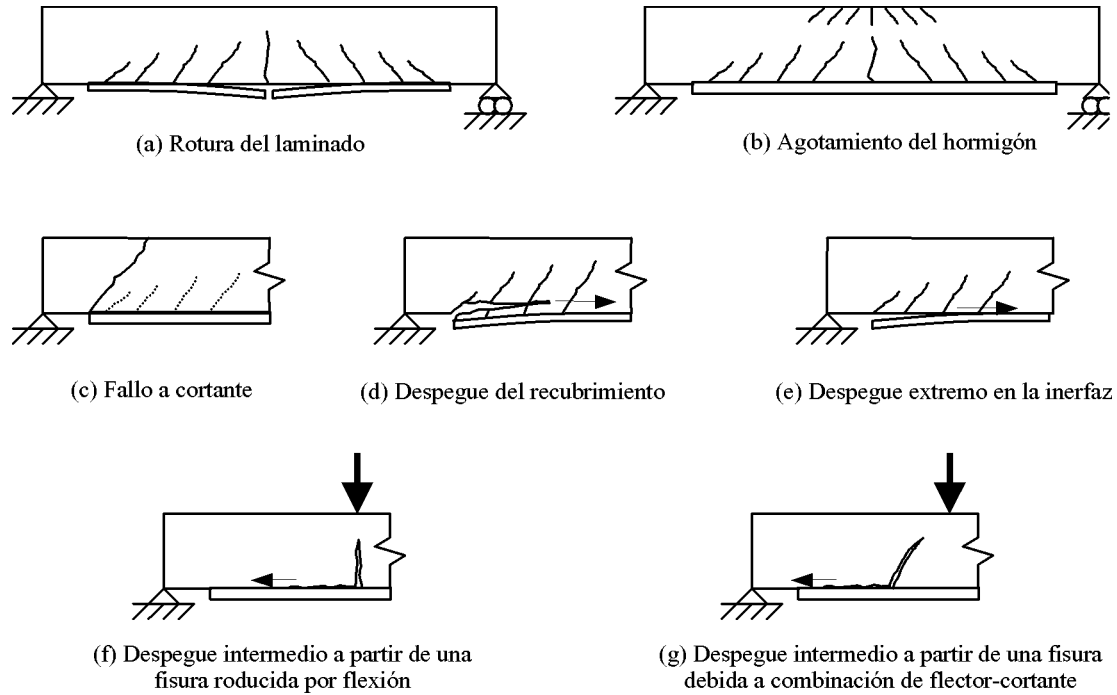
Modos de fallo de una viga de hormigón armado reforzada con un laminado de material compuesto.
